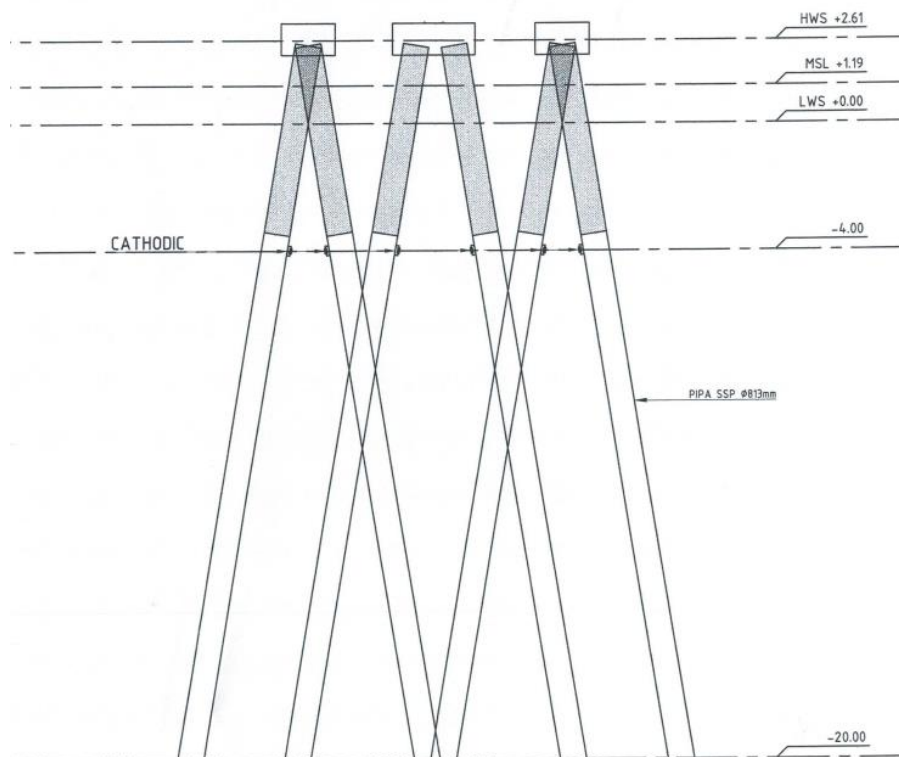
Layout Pancang Dermaga Segmen 3
